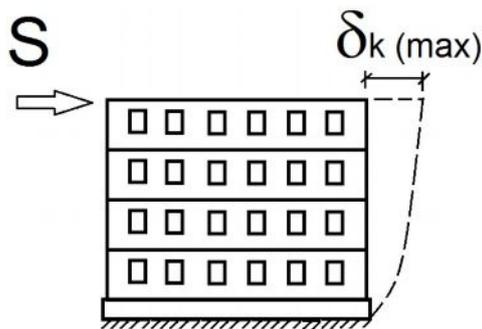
Схема перемещения здания: S – сейсмическая сила, действующая на здание; δ_{kmax} – величина перемещения k -го этажа здания
